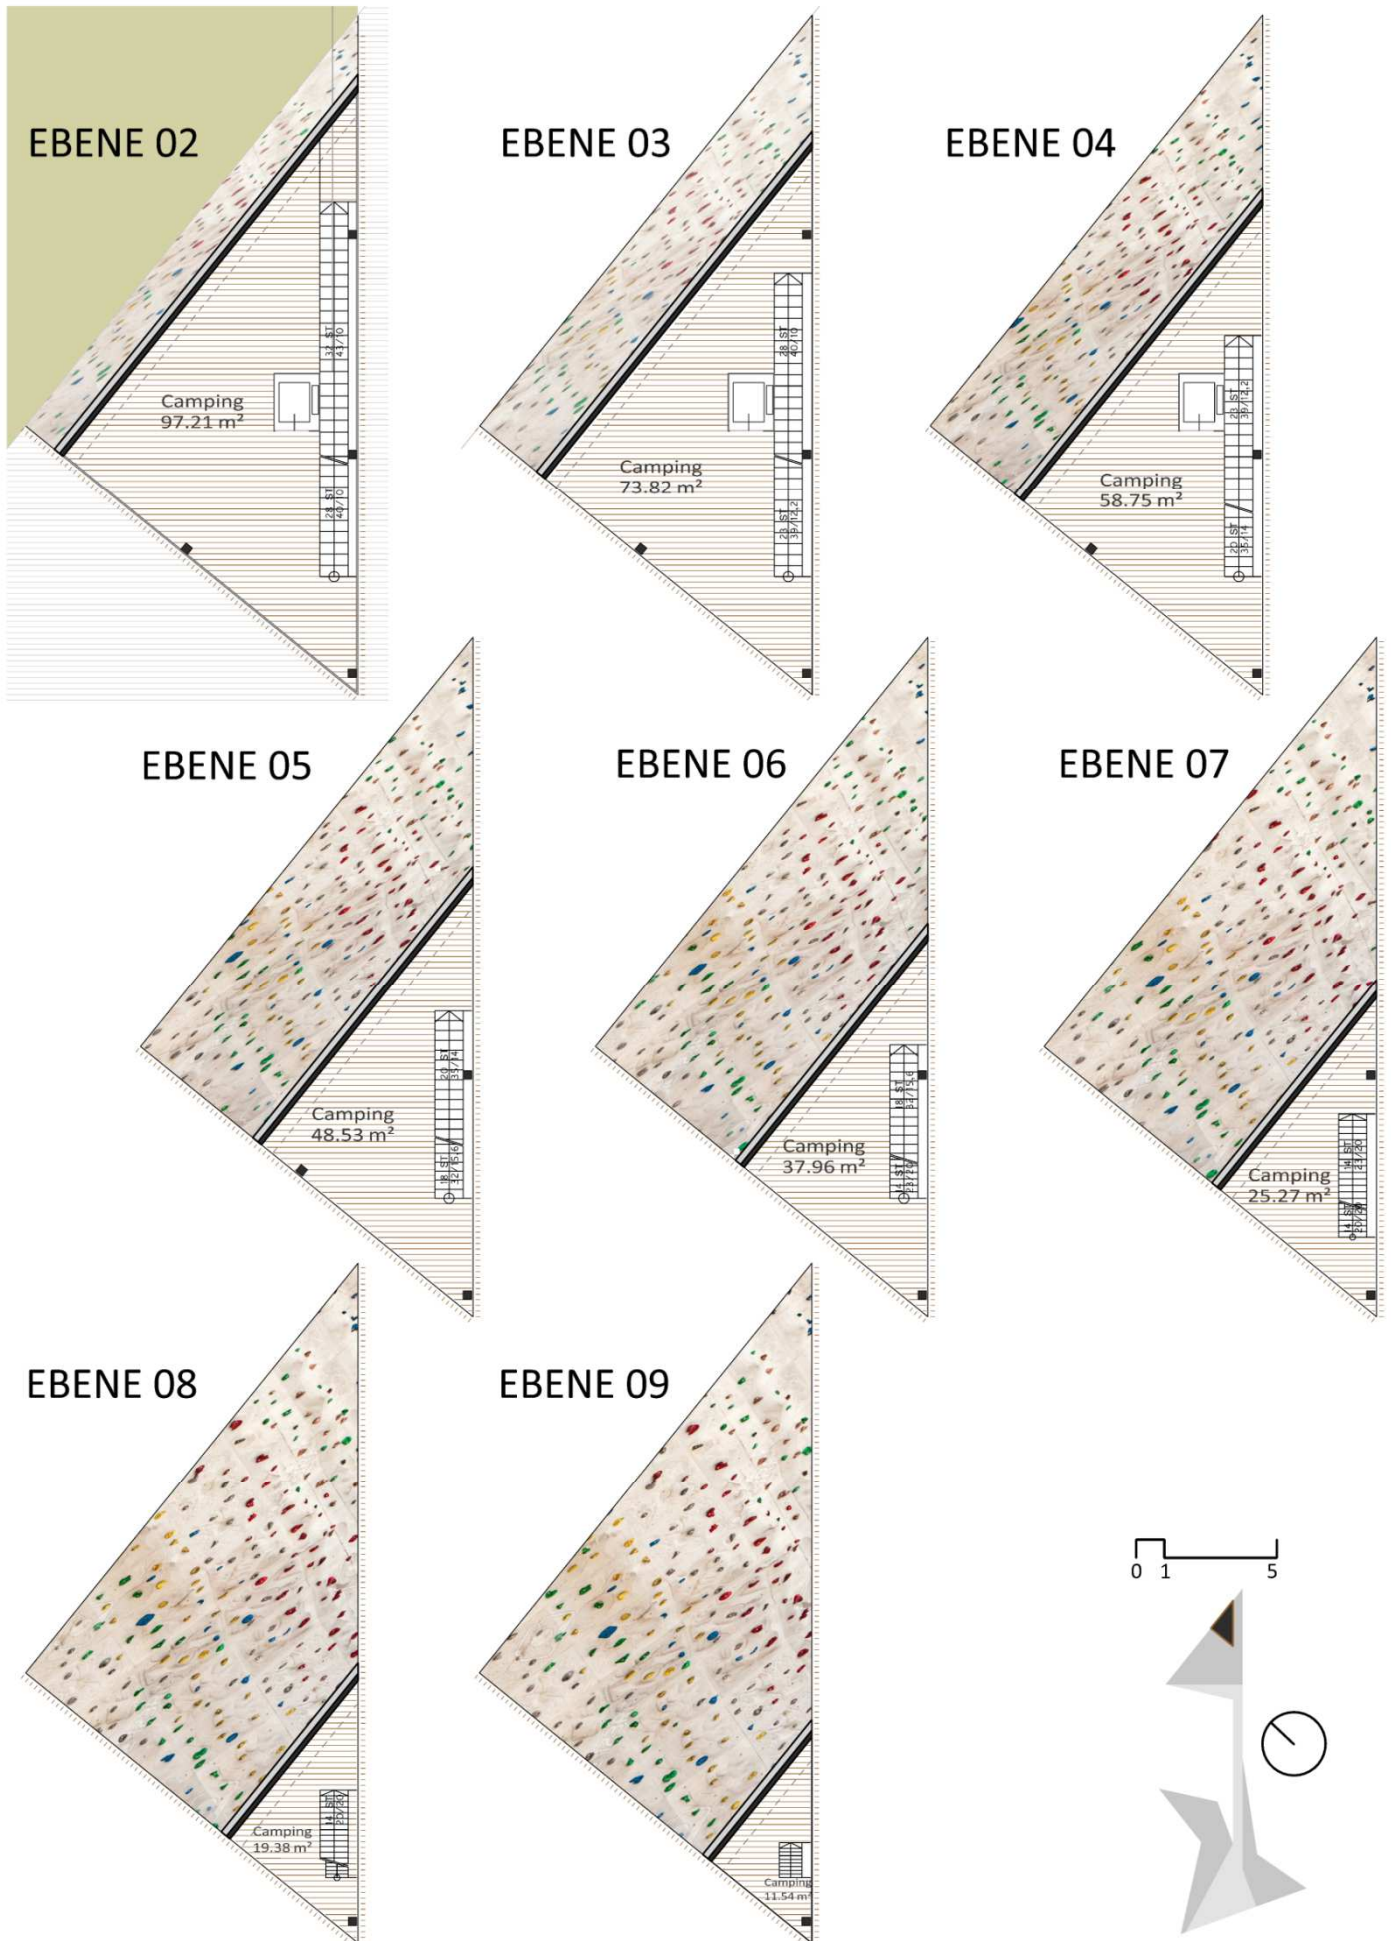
Baukörper „Fels“ Grundriss Ebene 02 bis Ebene 09
